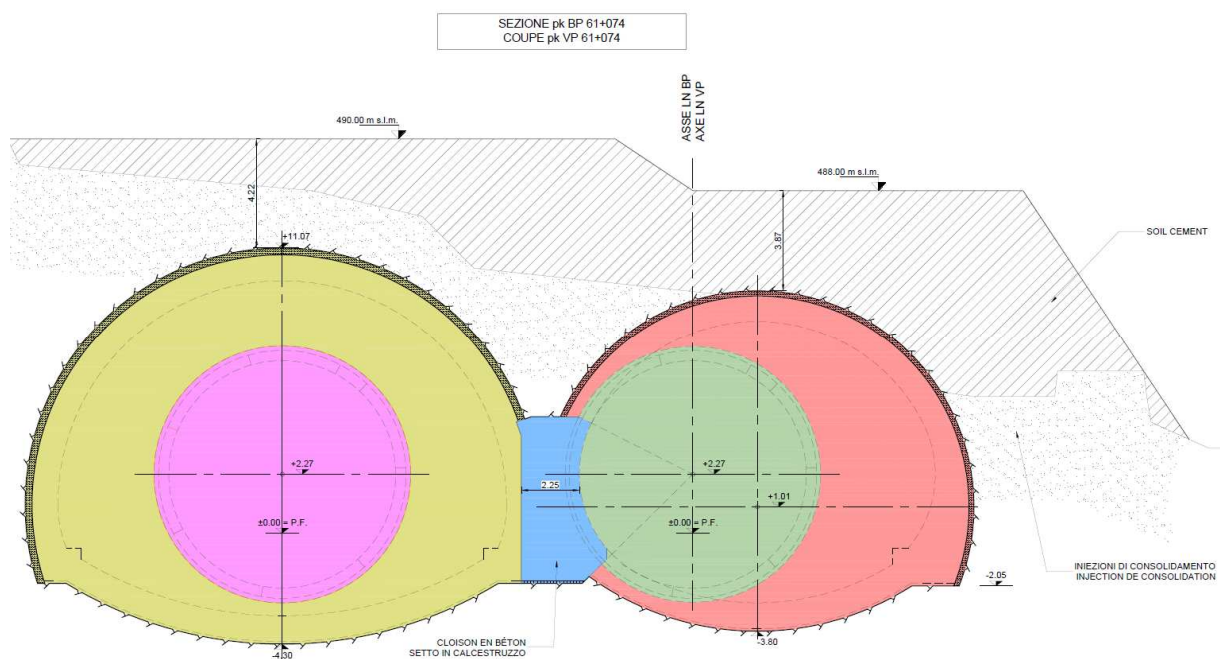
Profilo delle sezioni allargate all'imbocco Est del Tunnel di Base (PRV_C3A_7617_33-02-02)
